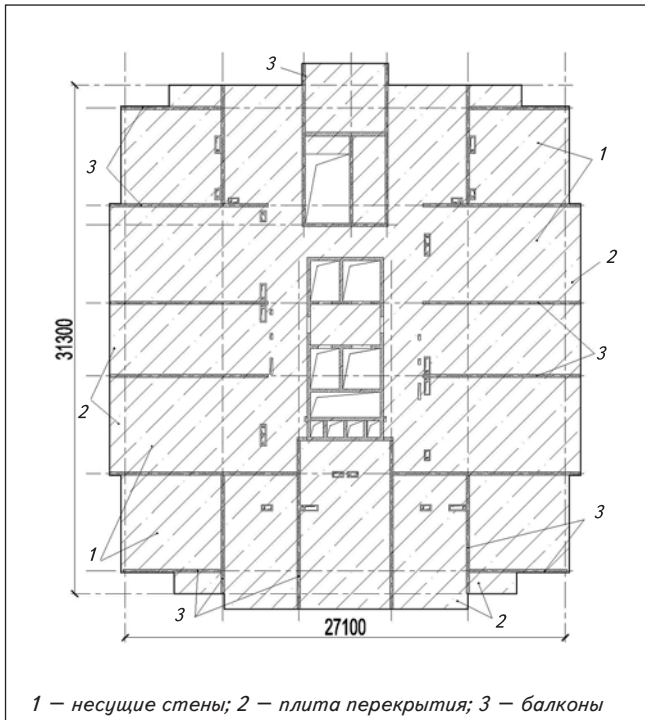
Размещение конструктивных элементов (план) в несущем каркасе здания
